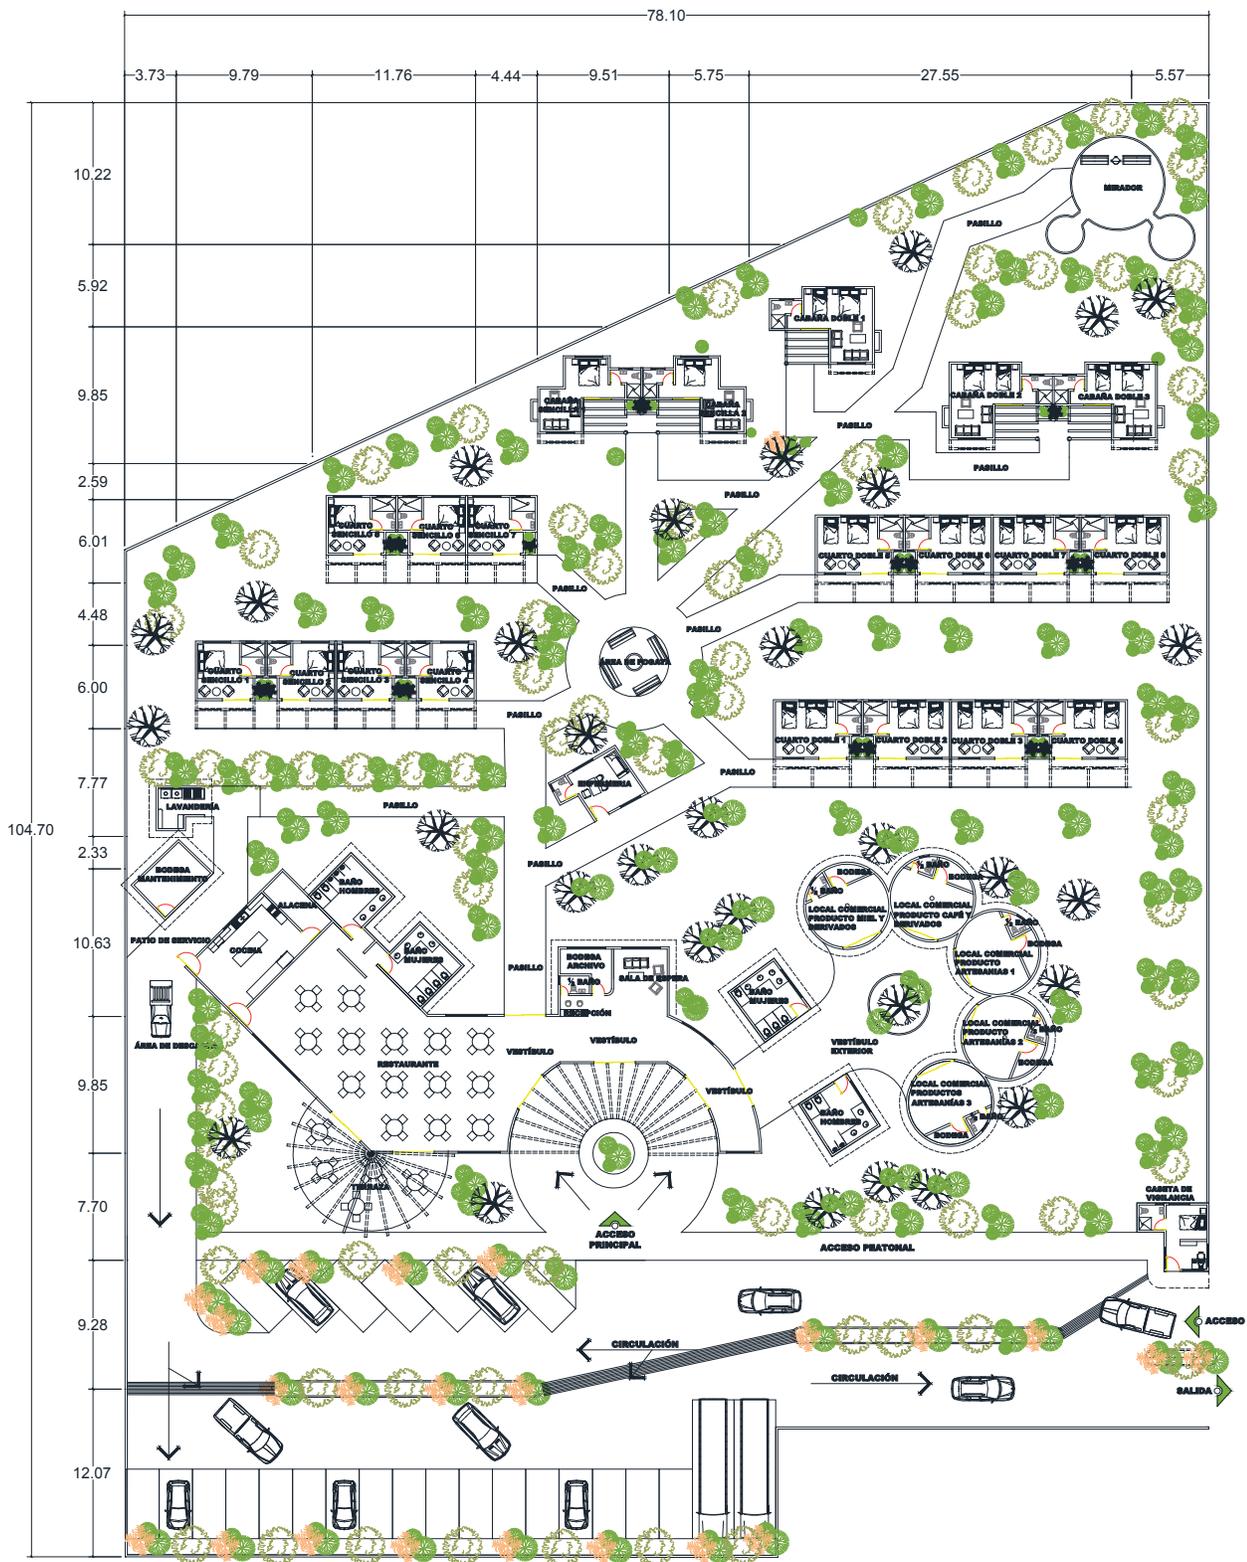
| Planta arquitectónica del anteproyecto 2.
